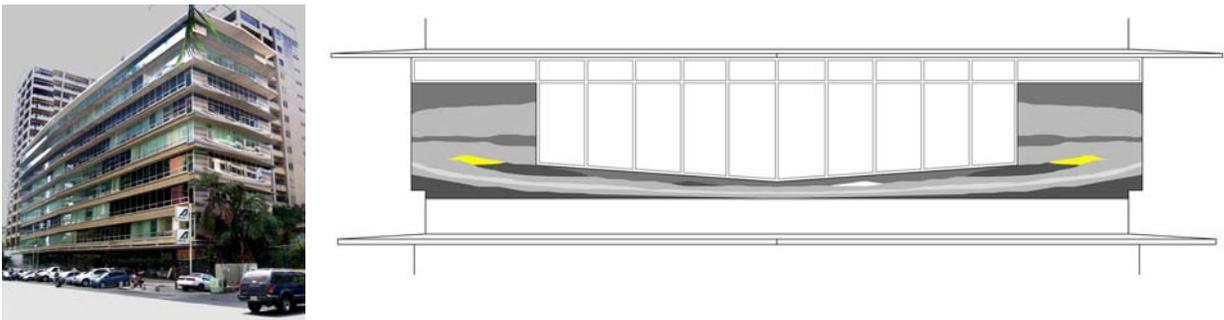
Foto Edificio Atlantic y detalle de fachada
